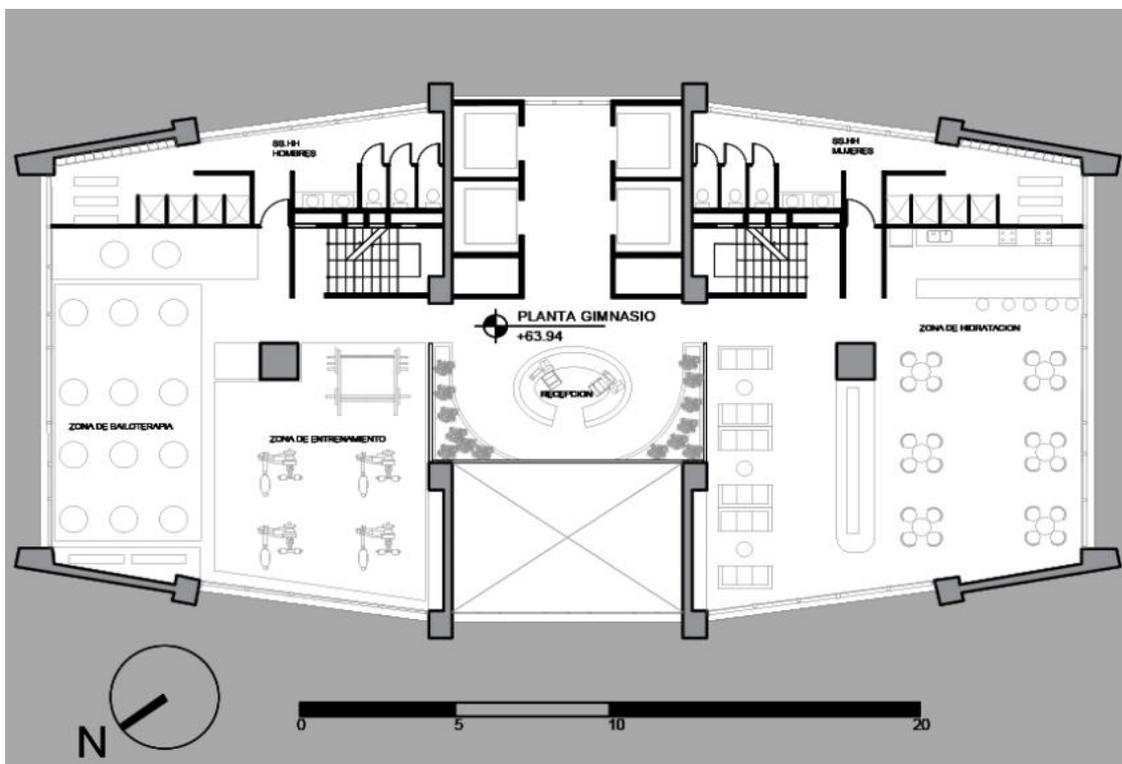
PLANTA NIVEL 19. Elaboración Propia.
